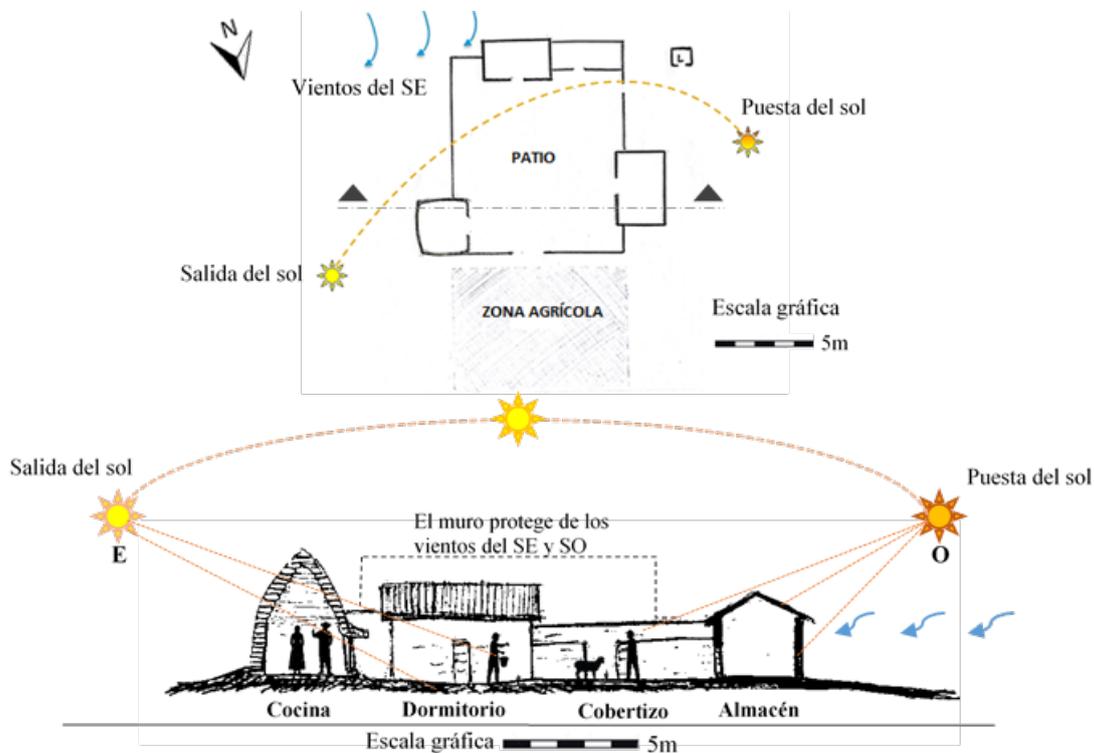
Planta y sección de la vivienda tradicional del maestro constructor y sus orientaciones
